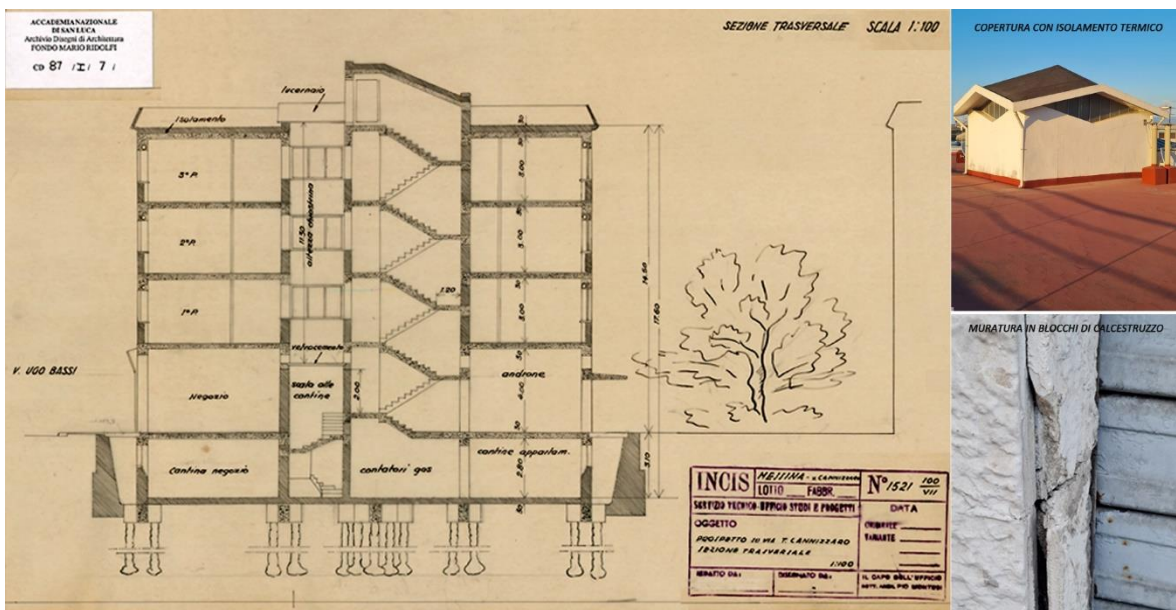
Sezione trasversale di un corpo di fabbrica e foto dettagli costruttivi - © Fondo Ridolfi-Frankl-Malagricci
